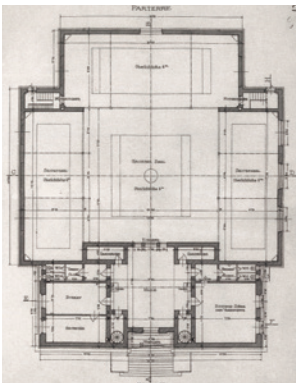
Joseph M. Olbrich, Grundriss Secession, Wien, 1898
